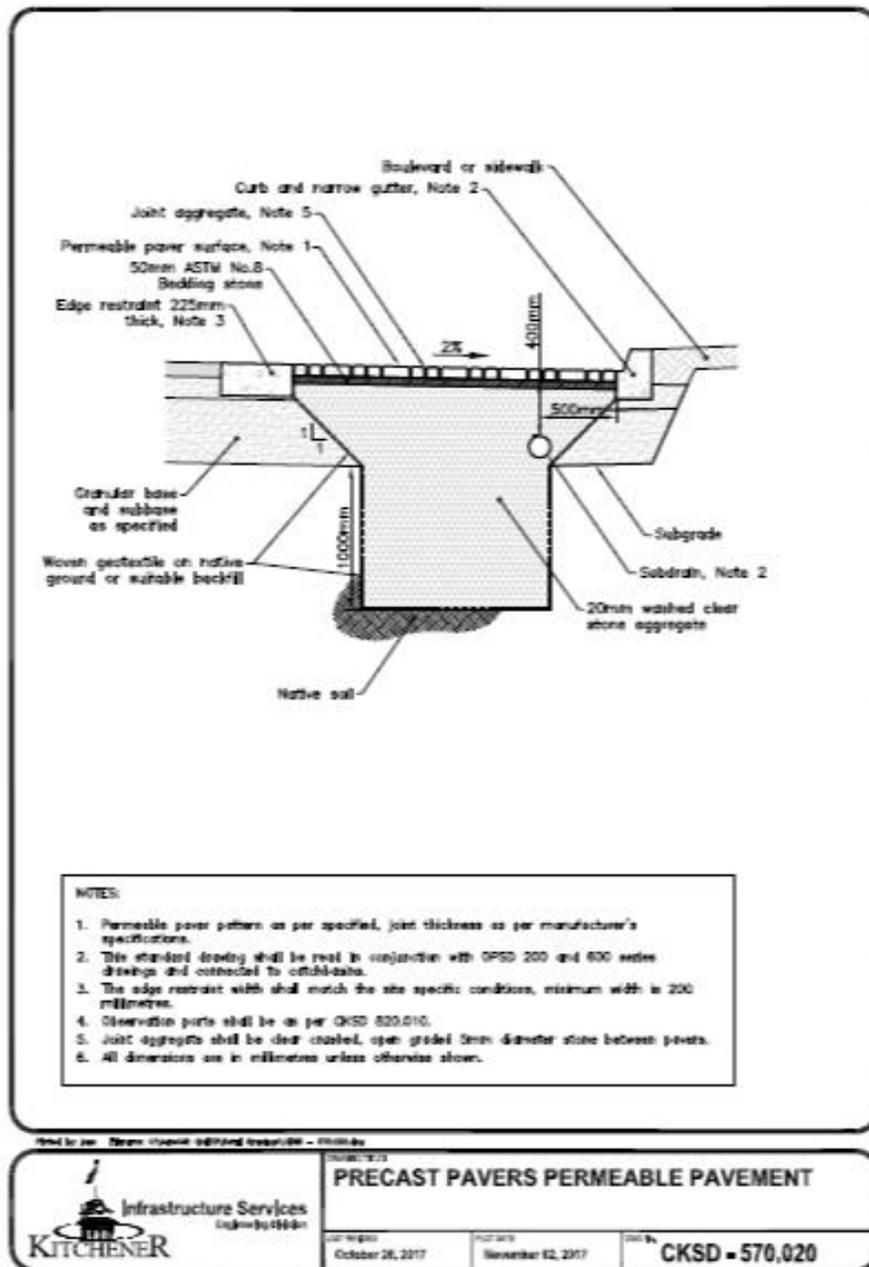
Dessin aux normes de conception de Kitchener pour des chaussées perméables prémoulées. Source : ville de Kitchener
